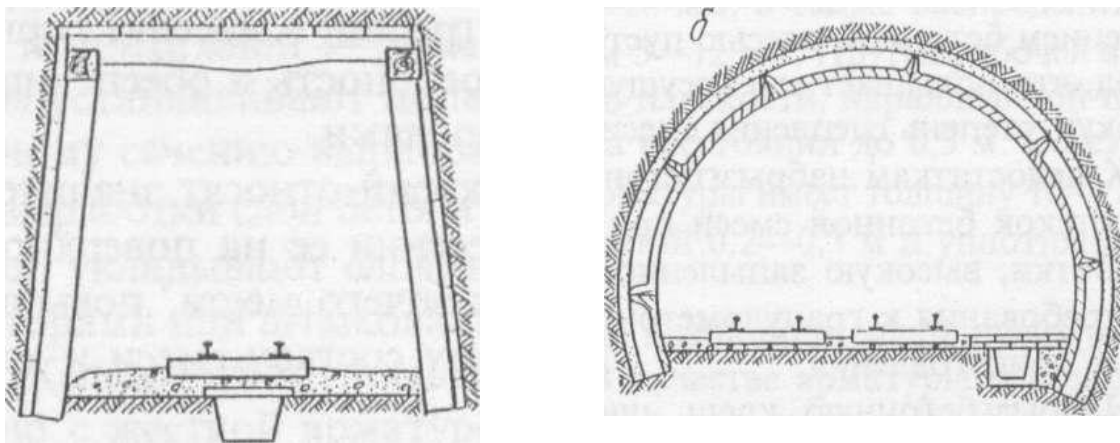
Сборная железобетонная крепь: а – трапецевидная; б – сплошная арочная из тюбингов
